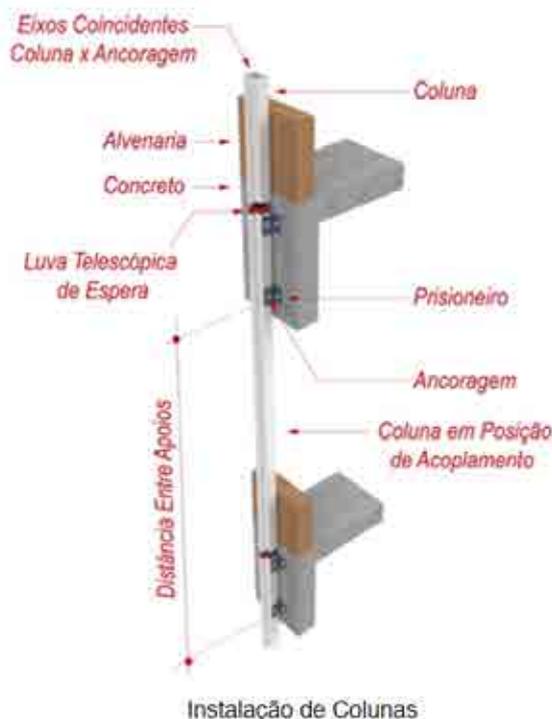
Sistema de fixação das colunas (Sistemista Perfil Alumínio)
